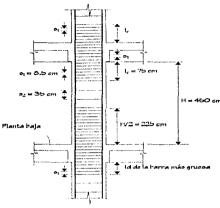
Refuerzo transversal de la columna 12 del eje 2, entrepiso PB-N1, estructura diseñada en condiciones de la zona li
